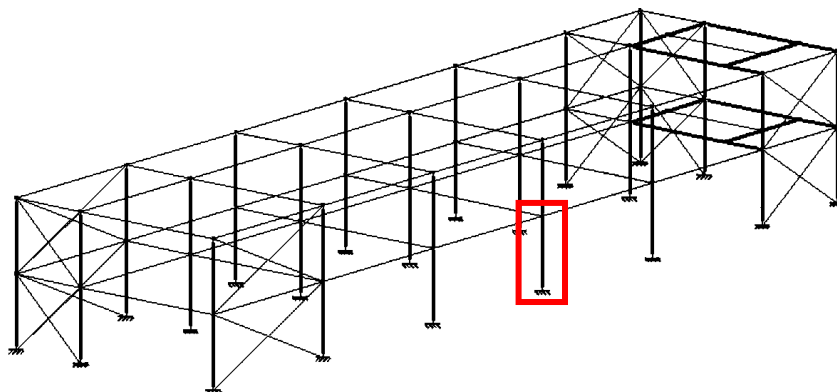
Pilar utilizado para el cálculo del coeficiente de pandeo. Fuente: CYPE 3D.
